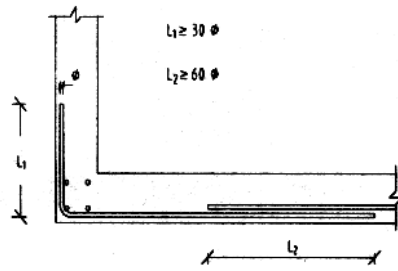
Lunghezza minima della sovrapposizione e del risvolto per armature orizzontali (Afv: armatura verticale - Afdv: armatura verticale diffusa)
